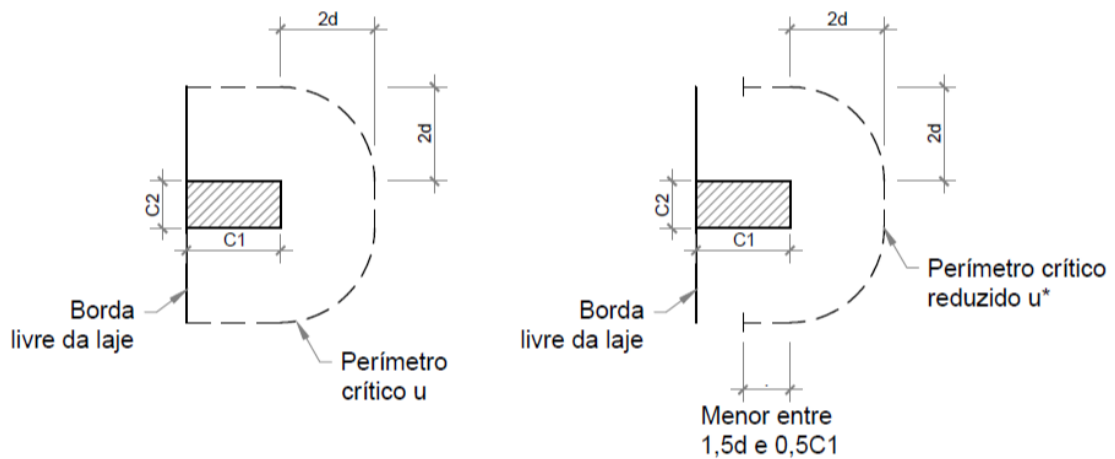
Perímetro crítico em pilares de borda (SILVA, 2017)
